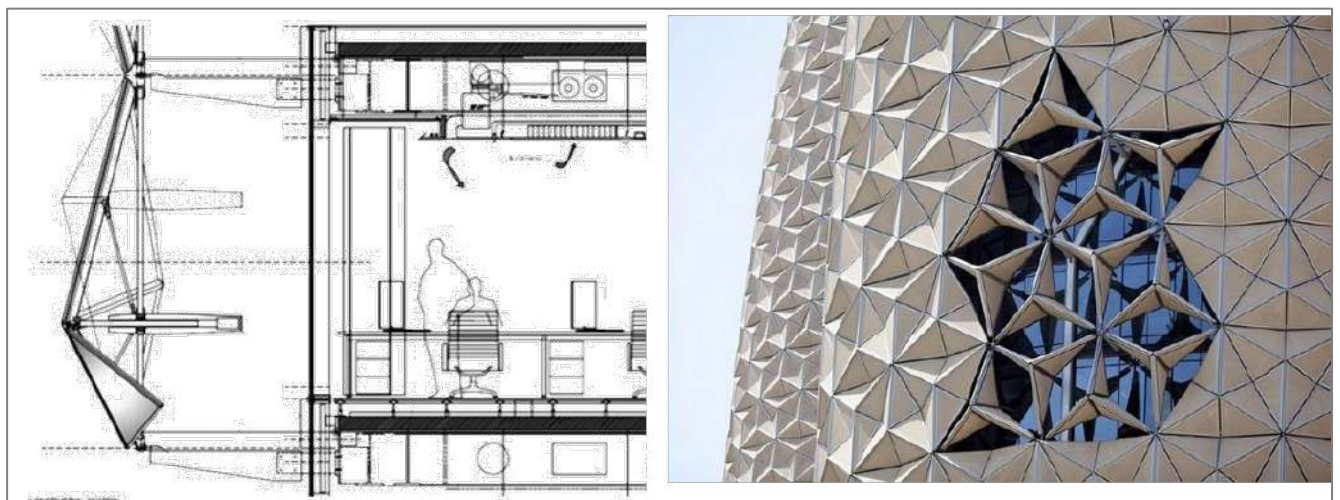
Динамічний фасад будівлі Аль-Бахр, ОАЕ
